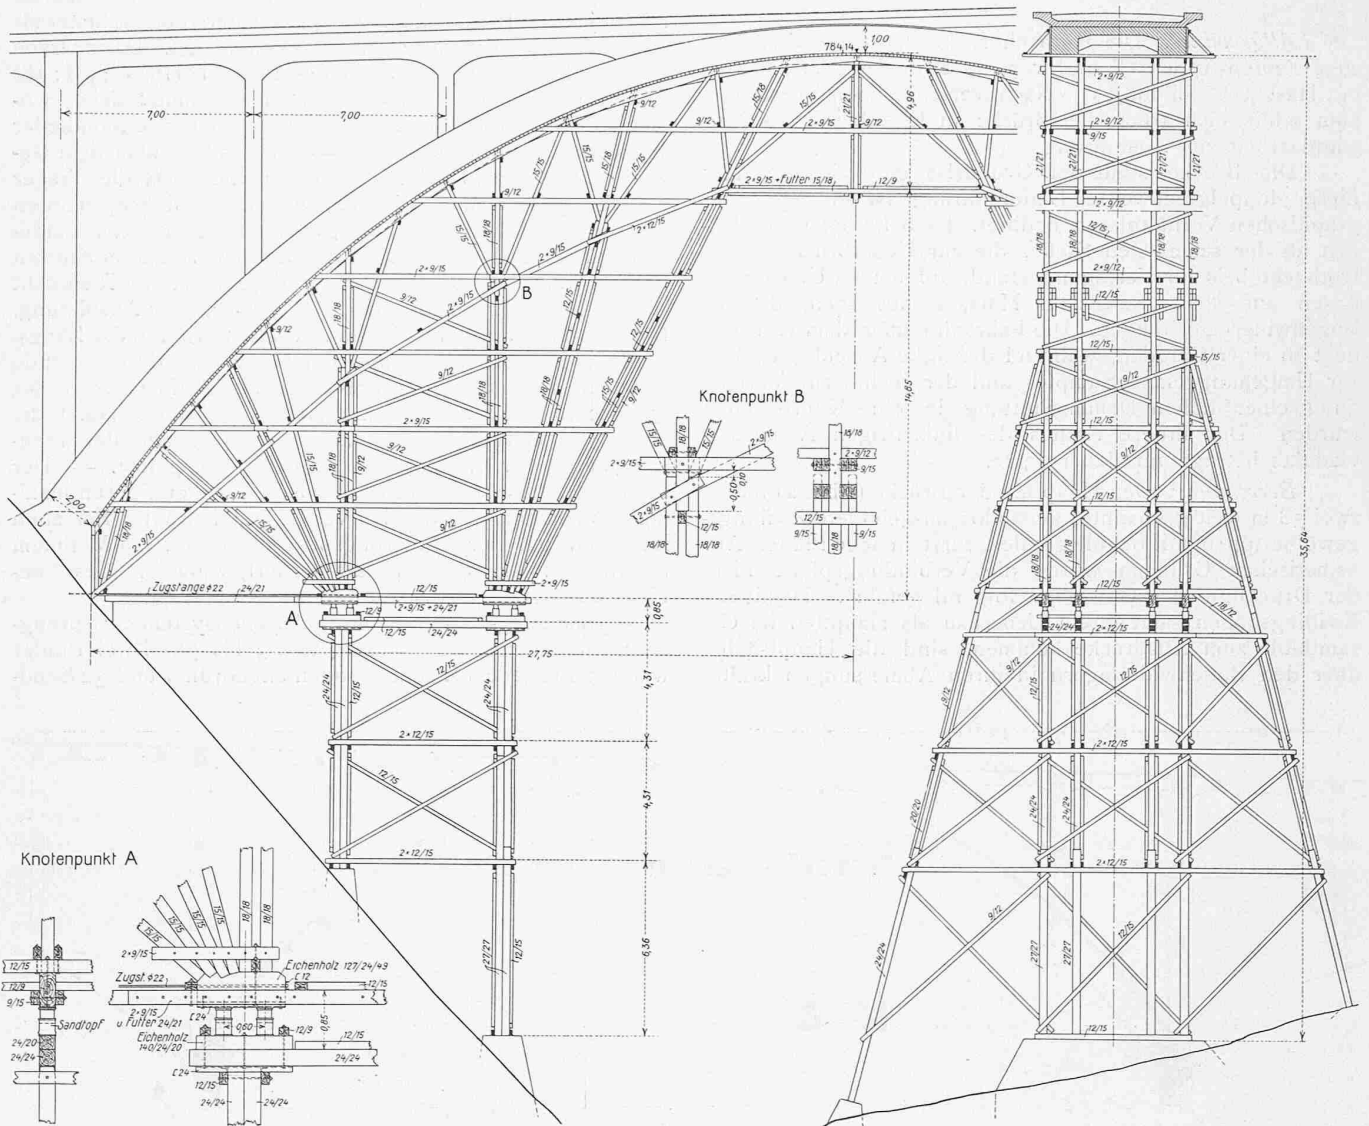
Lehrgerüst der Rotbachbrücke, Masstab 1 : 250. — Knotenpunkte A und B Masstab 1 : 100.
